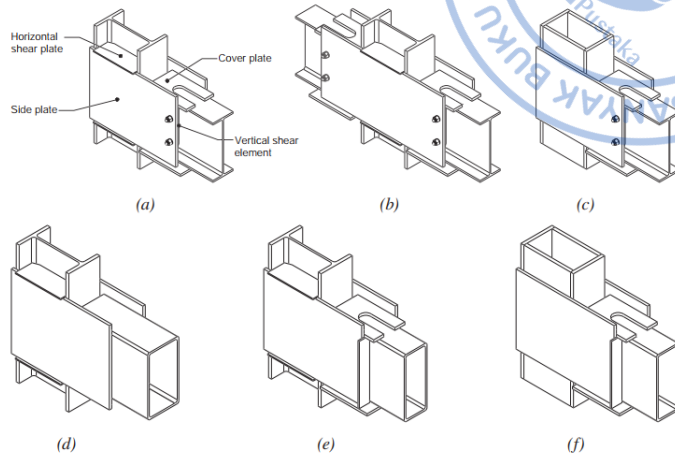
35. Kolom dengan Rakitan Collar Corner yang Terpasang
